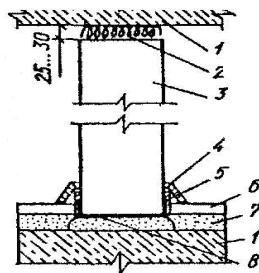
Вузол кріплення перегородок: 1 – панель перекриття; 2 – мінеральна вата, змочена в розчині; 3 – панель перегородки; 4 – плінтус; 5 – монтажна петля; 6 – скрутка із дроту; 7 – вирівнювальна стяжка; 8 – гідроізоляція
